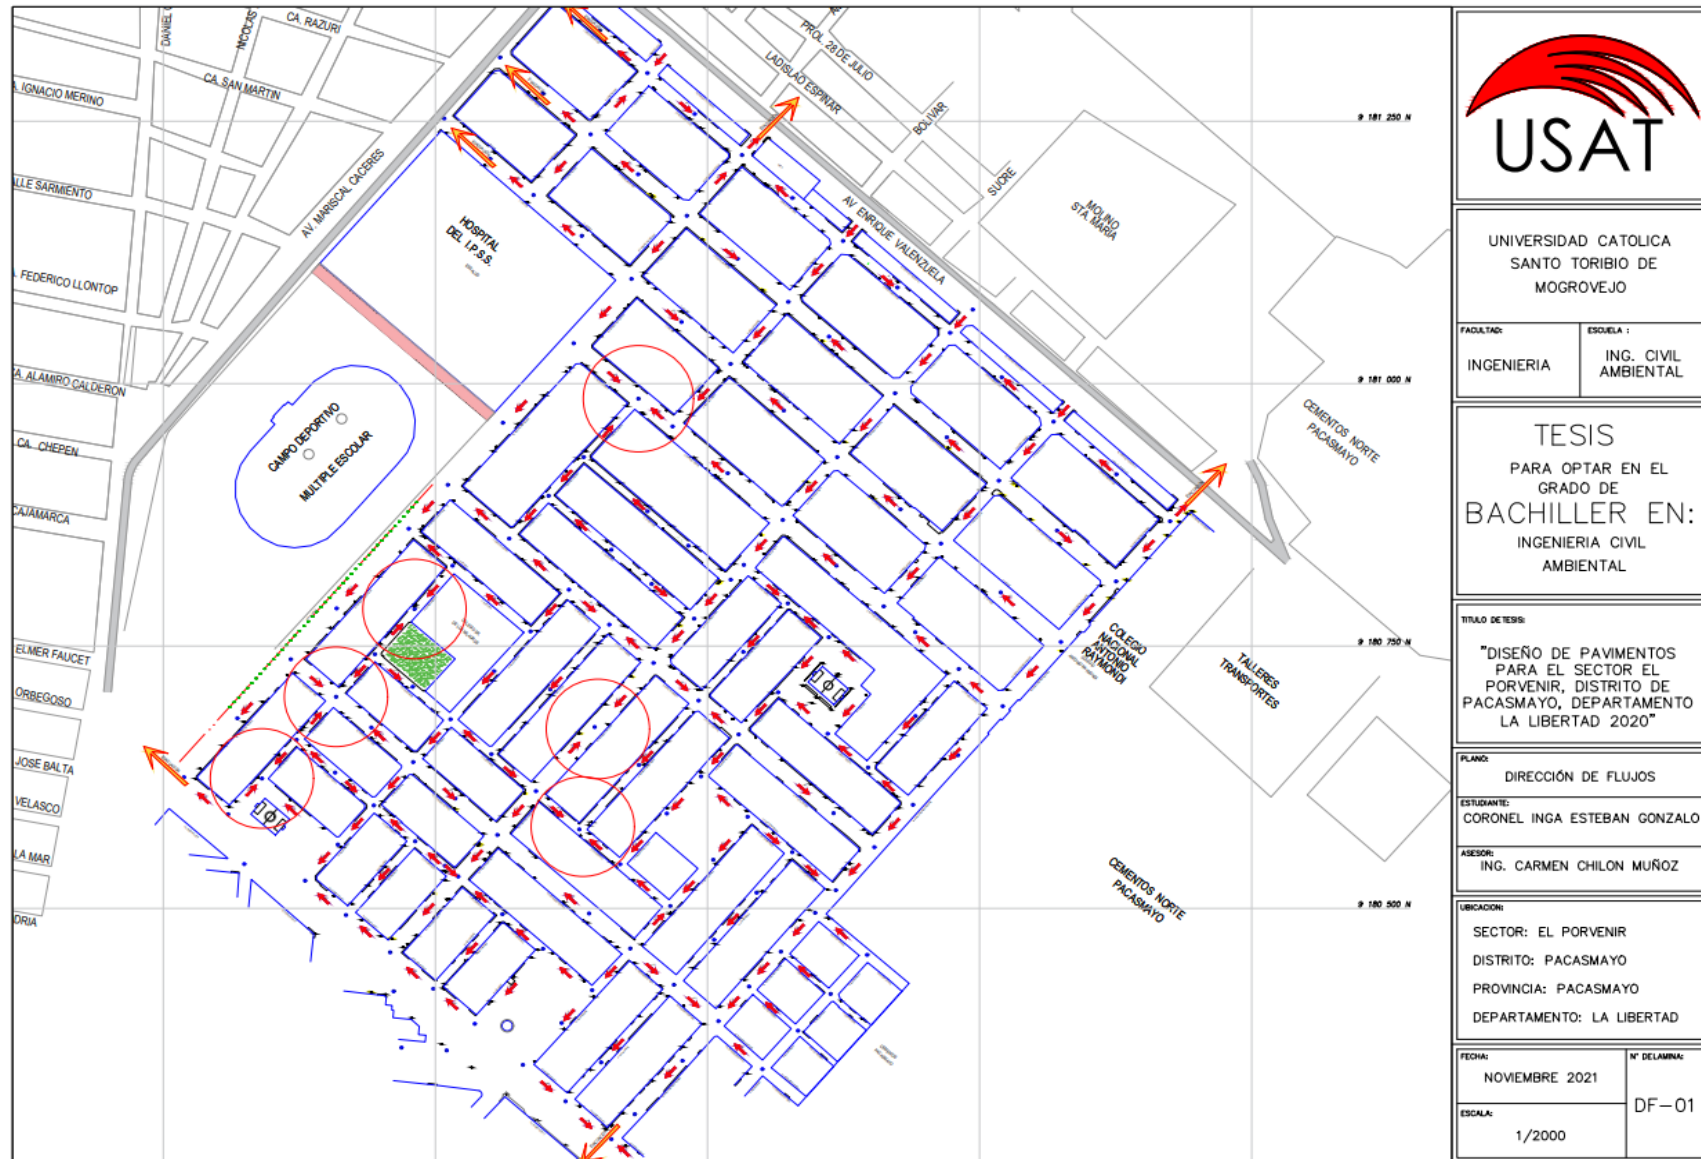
PLANO DE DIRECCIÓN DE FLUJOS DE DRENAJE PLUVIAL- FUENTE: ELABORACIÓN PROPIA
